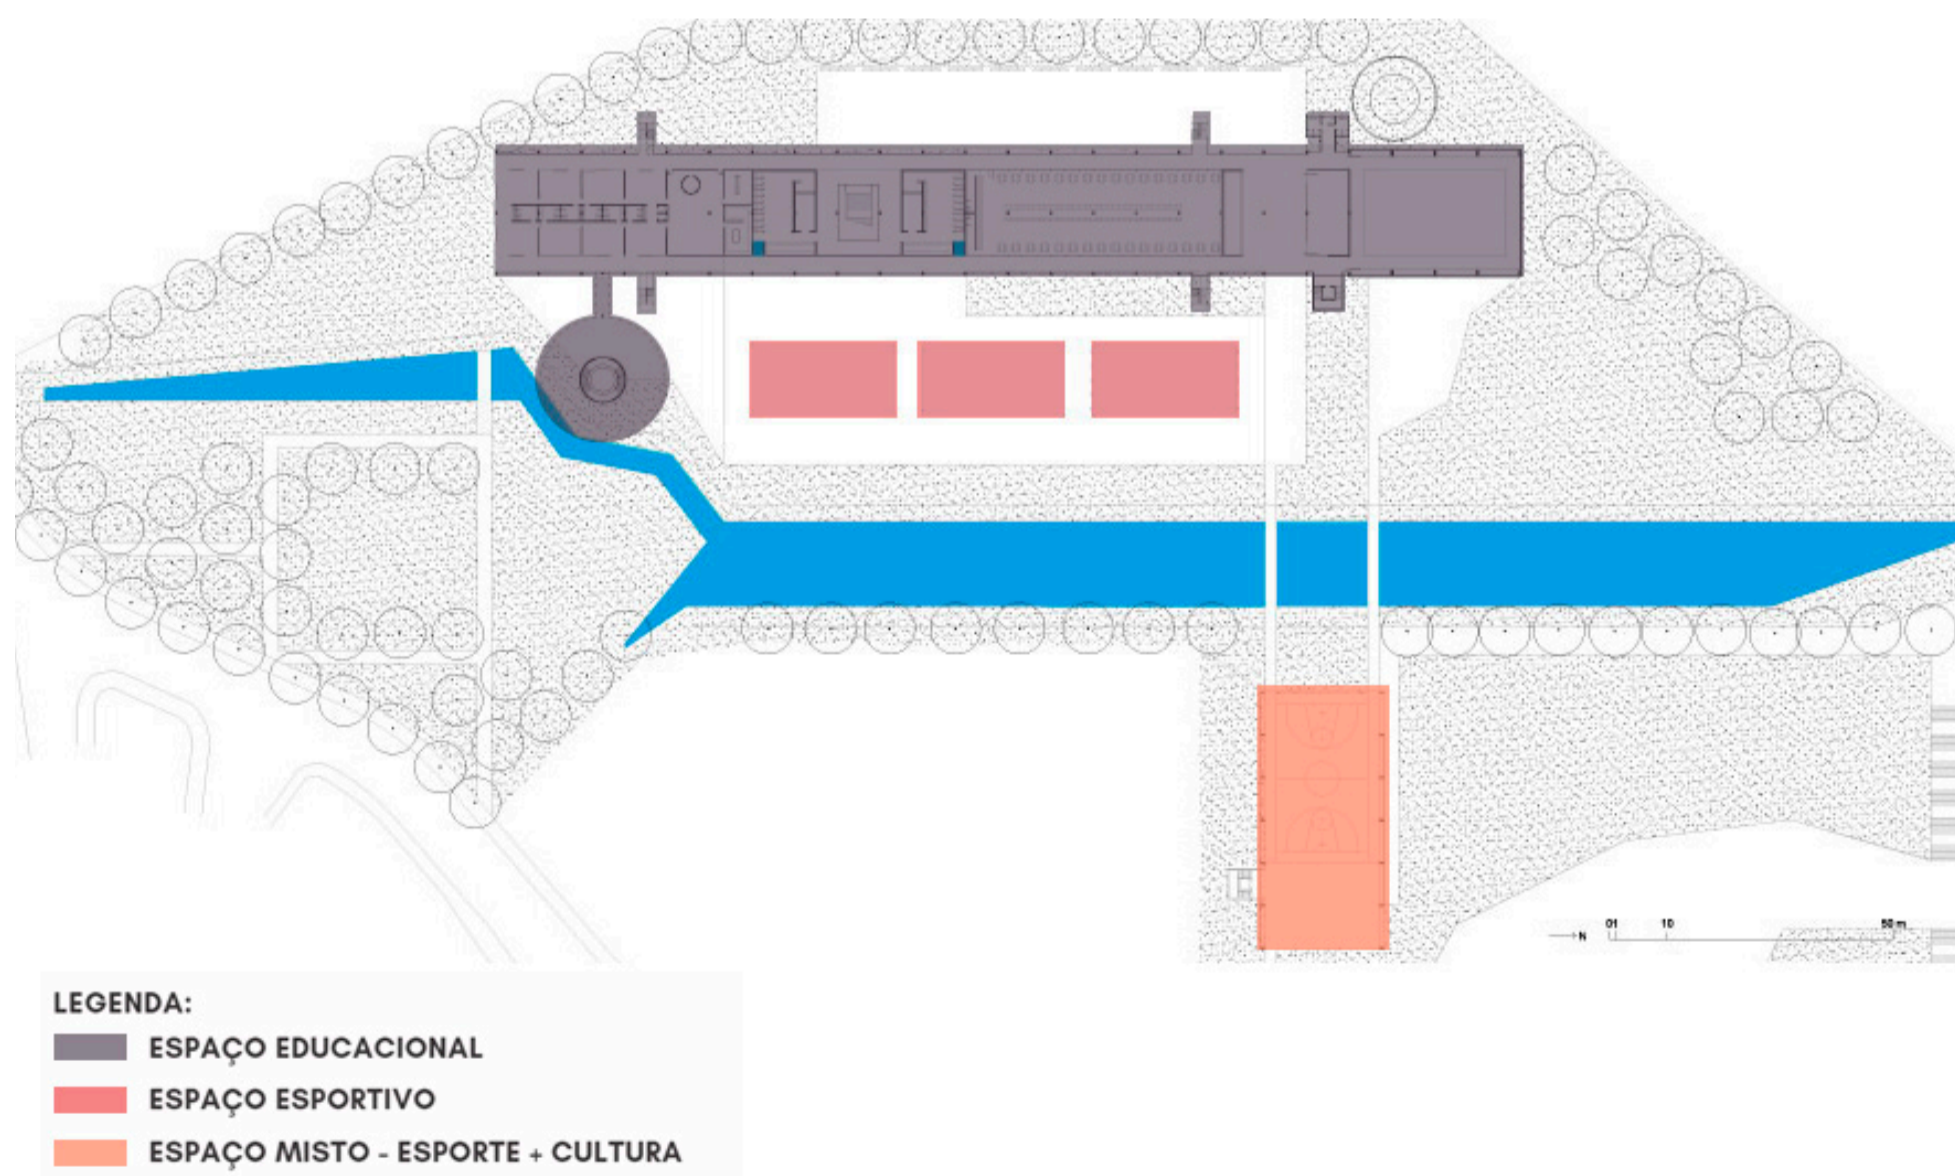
Planta de implantação do projeto CEU Butantã com análise de setorização. Fonte: Autora.
